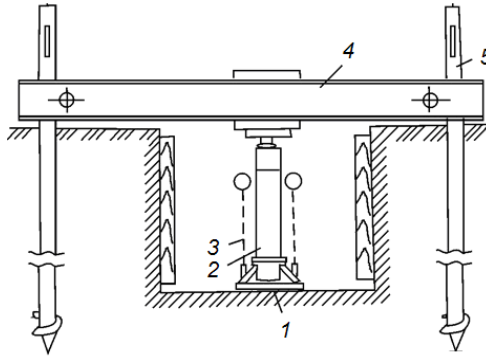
Схема испытания грунта штампом в шурфе:
